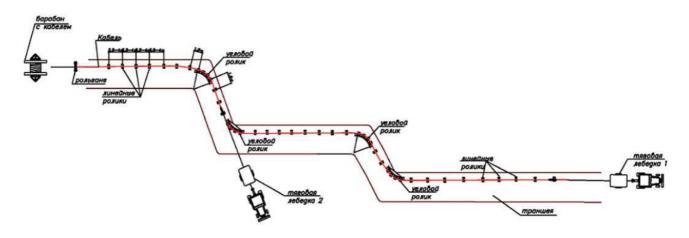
вариант монтажа кабеля двумя лебедками
